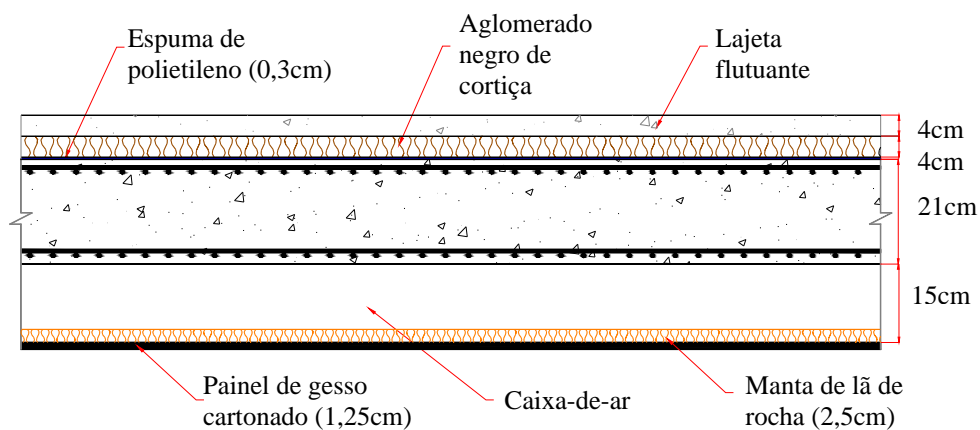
Pavimento de estrutura contínua em laje maciça de betão armado com tecto falso, isolante e lajeta flutuante (Pav6)
